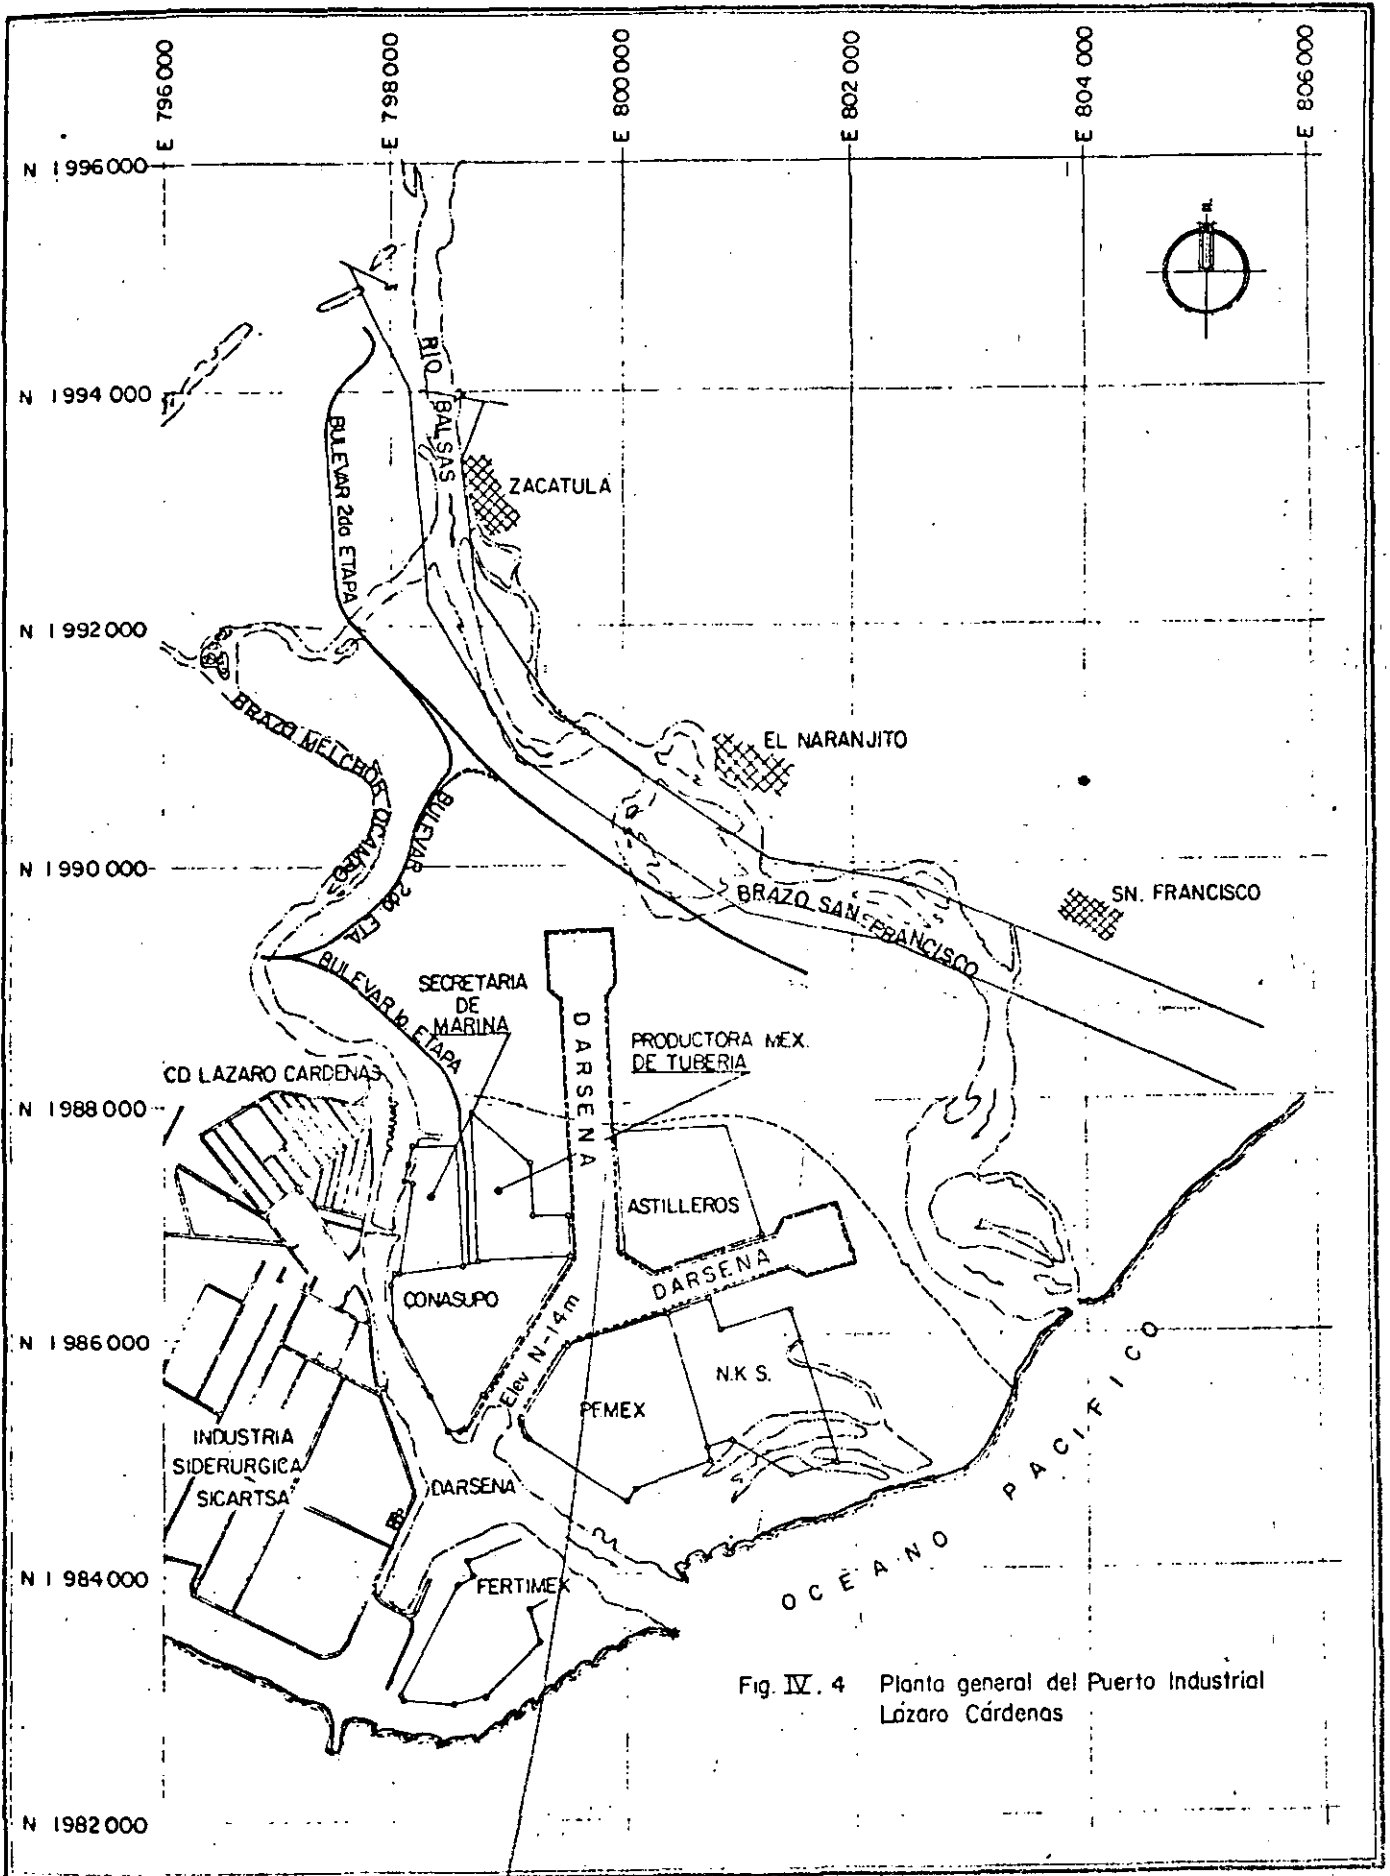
Planta general del Puerto Industrial Lázaro Cárdenas
